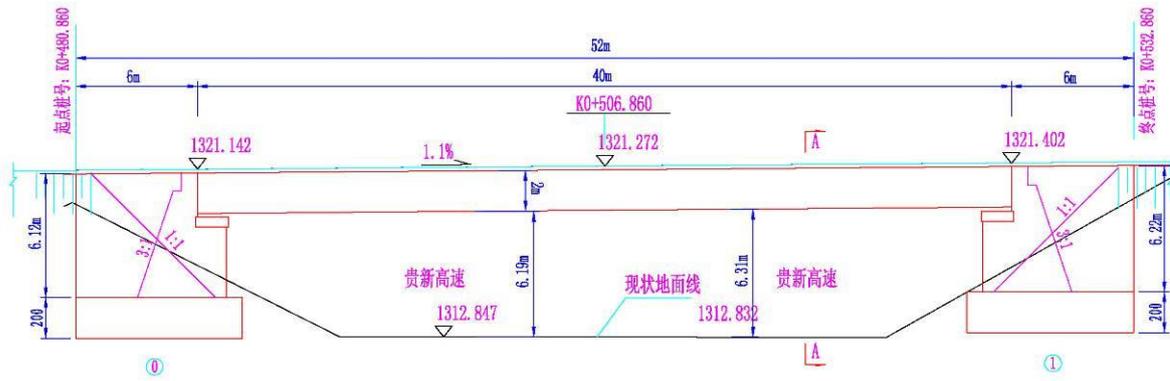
纵三路 K0+480.86~K0+532.86 桥梁处立面布置图
